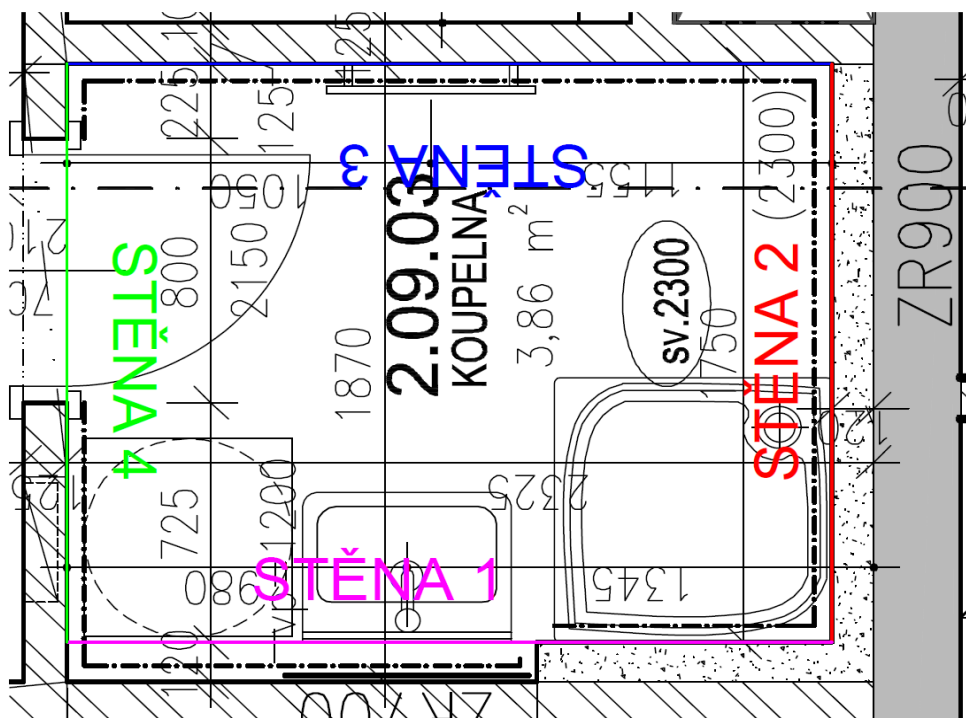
Měření přesahů v koupelně v bytě 1.02
